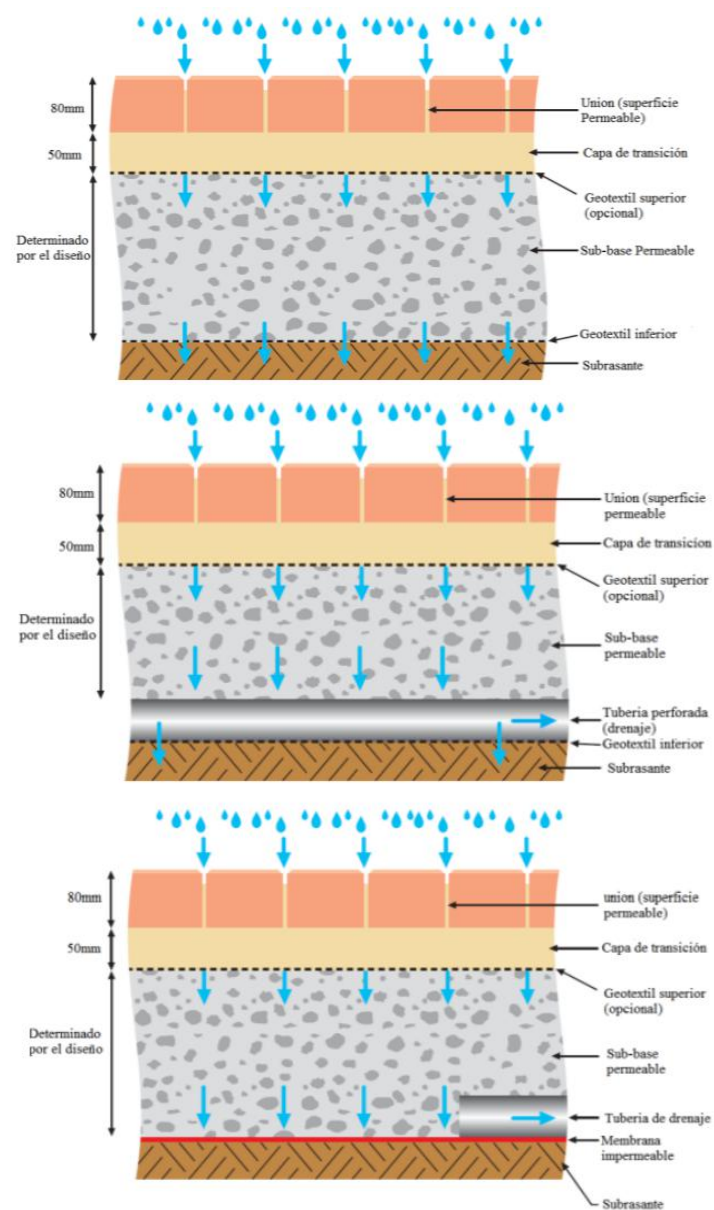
3 Estructuras de pavimentos permeables. (Interpave, 2008). Fuente: LEANDRO CASTRO ESPINOSA. Mario. (2011) "Pavimentos permeables como alternativa de drenaje urbano" TFG
